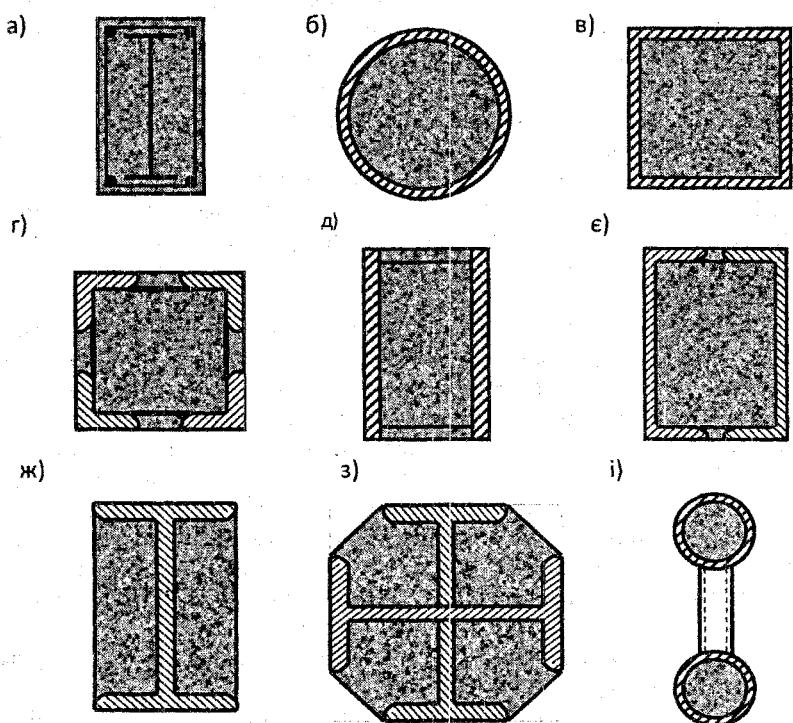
Поперечні перерізи сталезалізобетонних колон:
